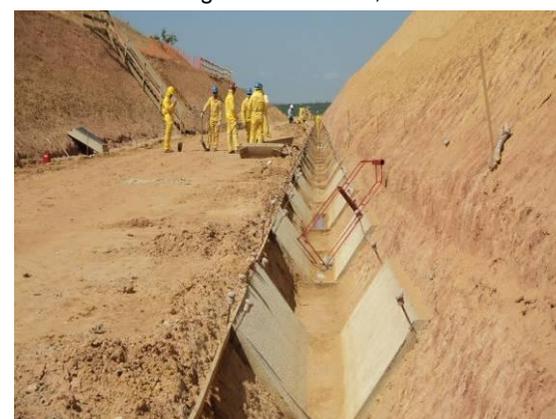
Execução do sistema de drenagem do corte 64, estaca 73070.
